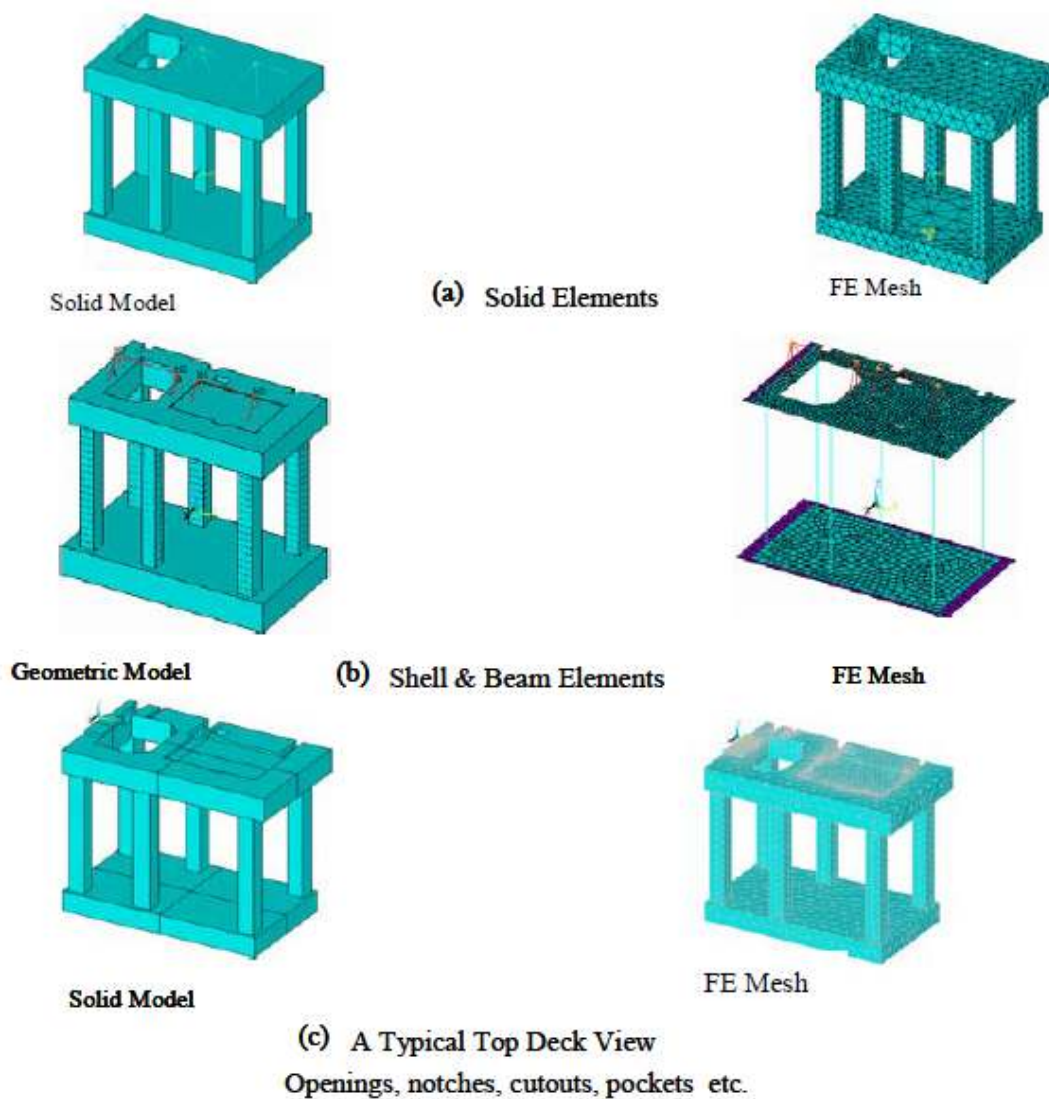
Fondation support en portique-modèle en élément solide, coque et poutre
